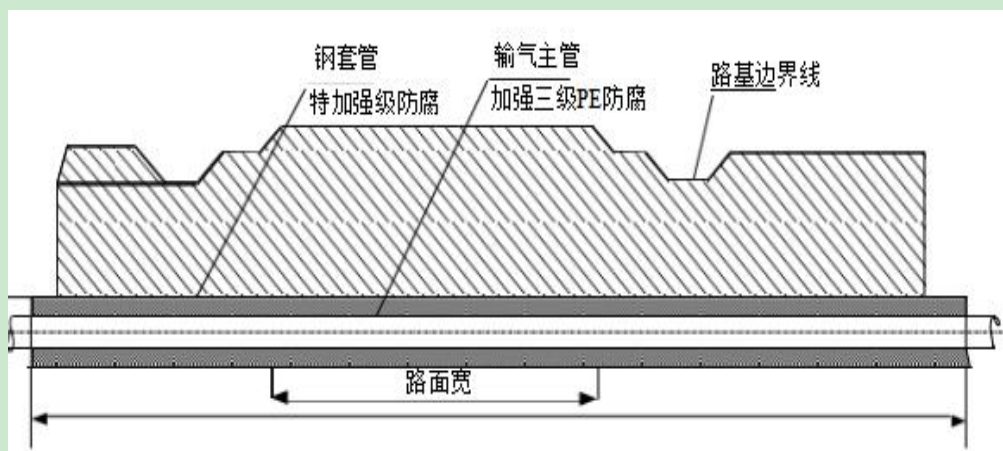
乡村水泥道路、机耕道穿越施工方式断面示意图
